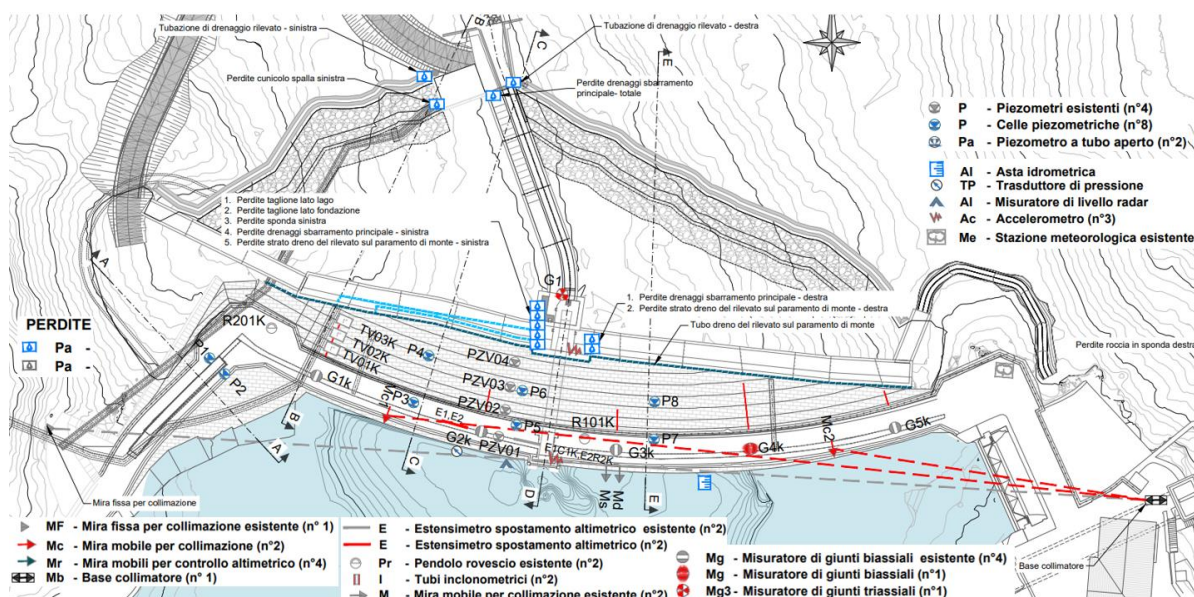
Sbarramenti principale e secondario: planimetria con indicazione della tipologia dell'ubicazione della strumentazione di monitoraggio (esistente e di nuova installazione)
